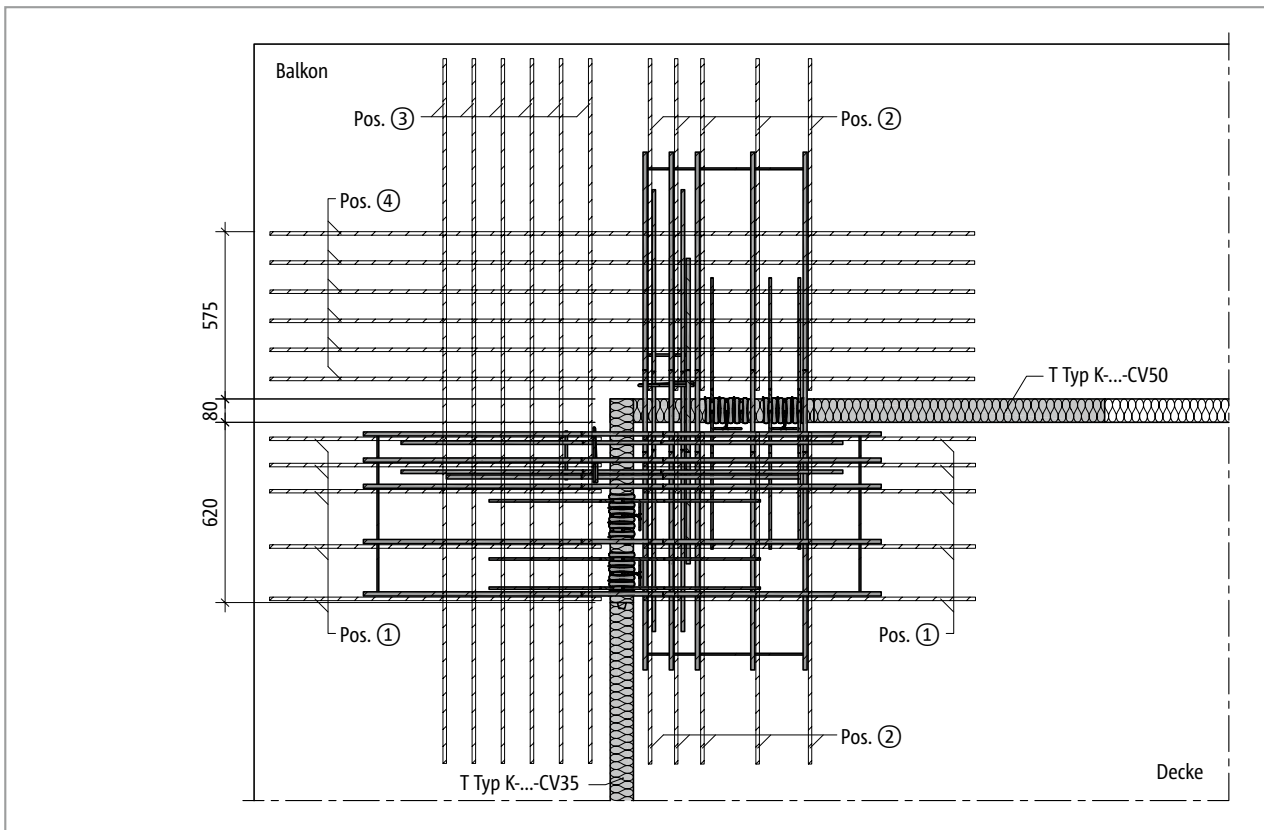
Schöck Isokorb® T Typ C-M2: Bauseitige Bewehrung (obere Lage)
